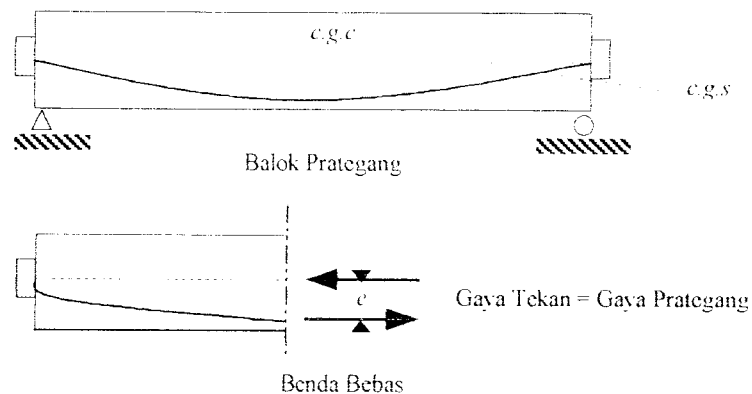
Distribusi tegangan sepanjang penampang beton prategang eksentris
